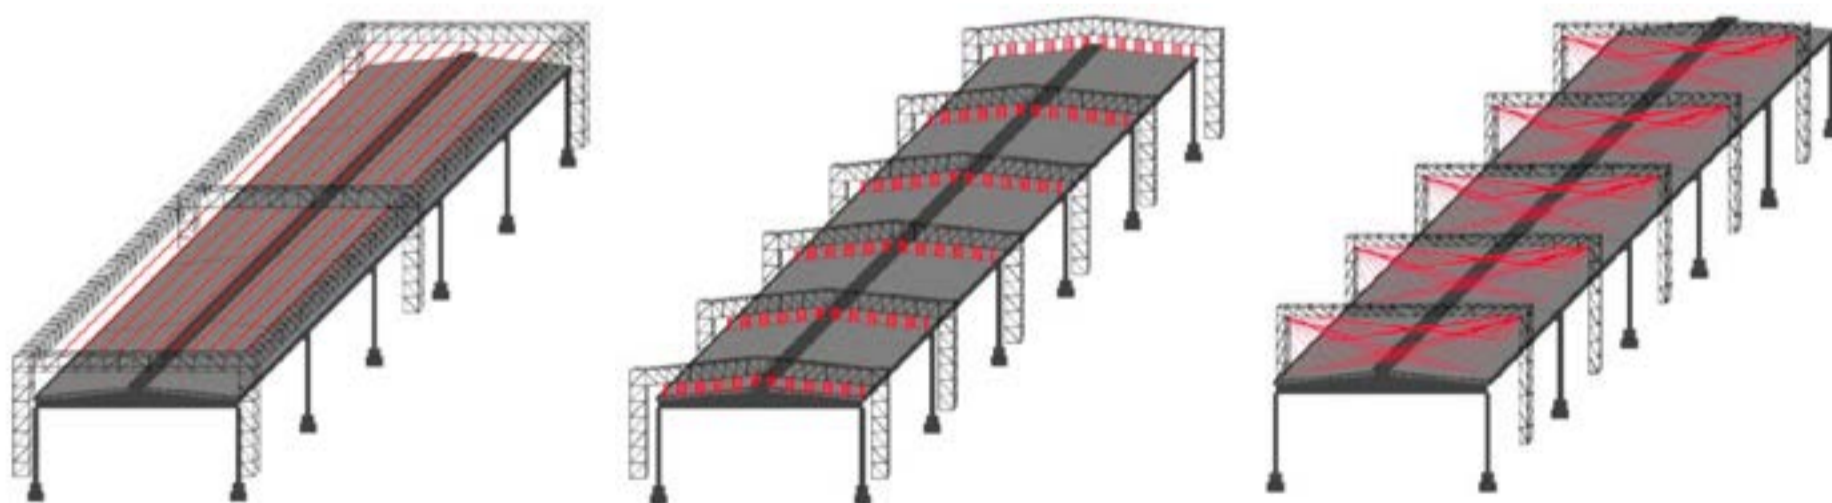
Sistema per impedire il collasso di un edificio, in particolare una struttura prefabbricata in calcestruzzo armato, per perdita di appoggio di almeno un elemento strutturale orizzontale
